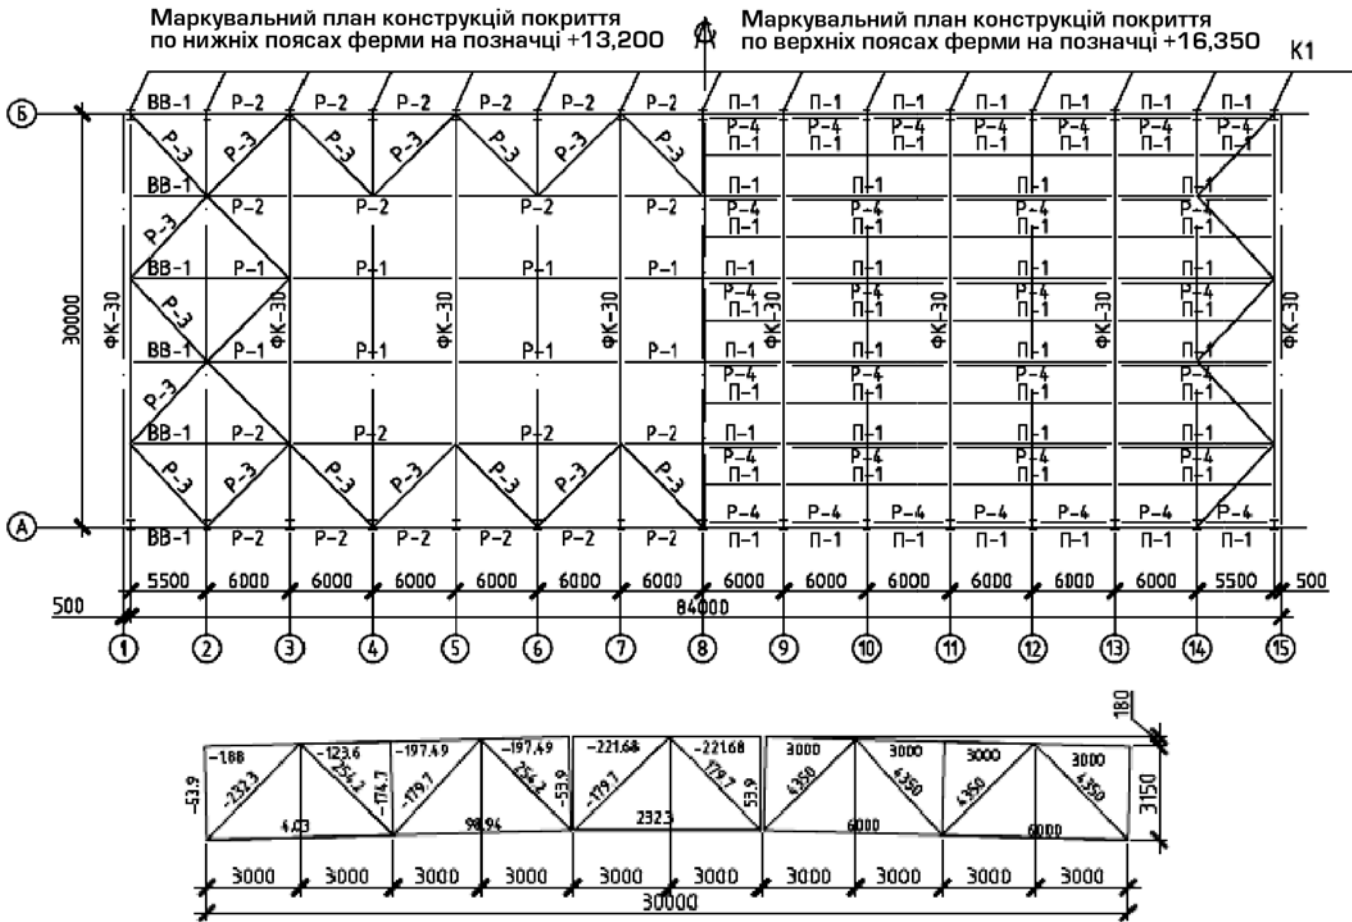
Маркувальний план по верхніх та нижніх поясах ферм покриття та монтажна геометрична схема ферми
